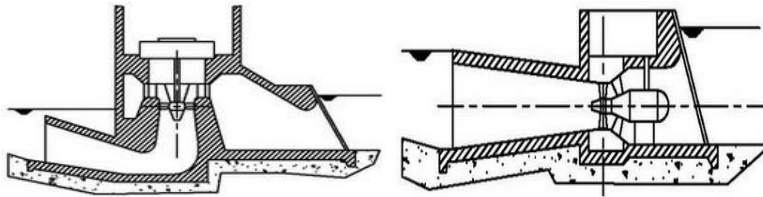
A sinistra sezione di una Kaplan ad asse verticale, a destra una realizzazione a bulbo
